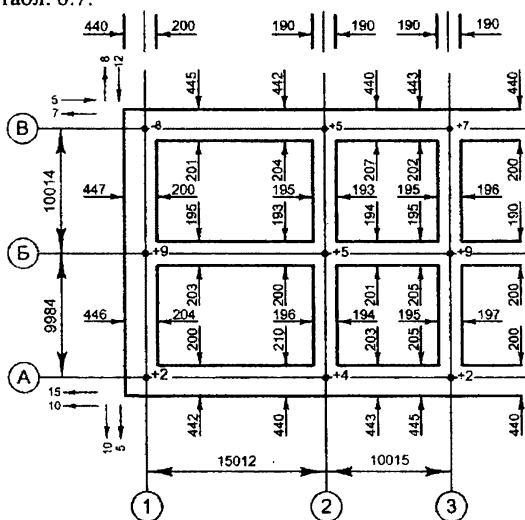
Исполнительная схема плано-высотного положения кирпичной кладки под перекрытие этажа
